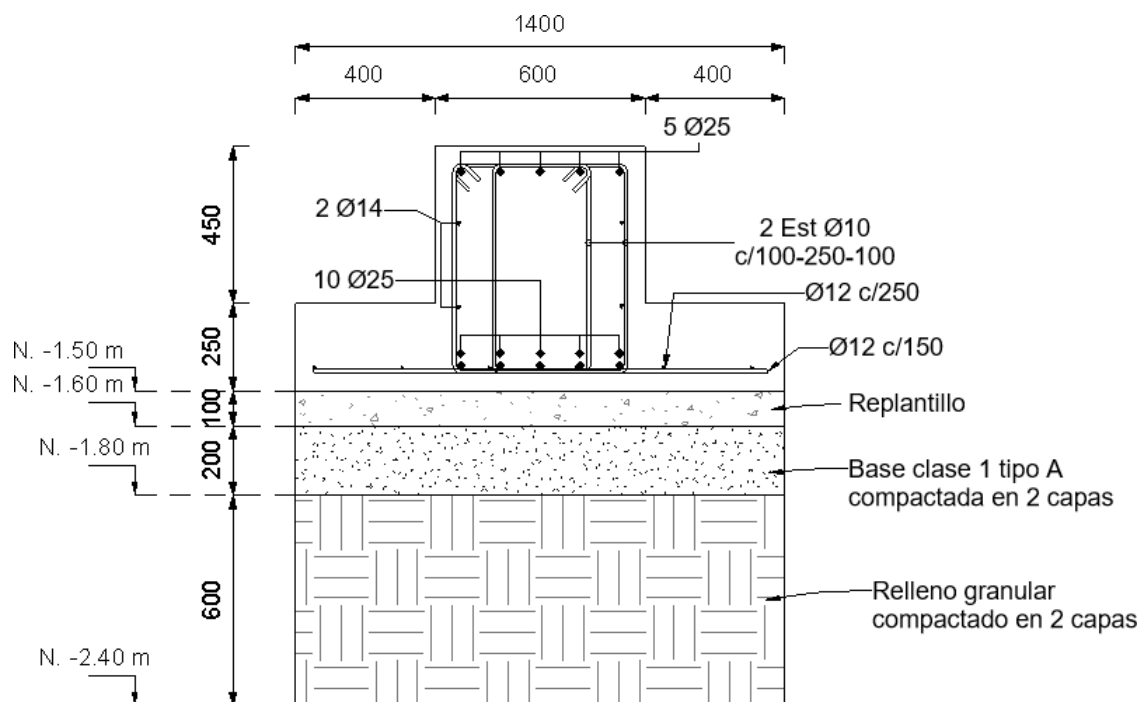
Sección transversal de la zapata. [Elaboración propia]
